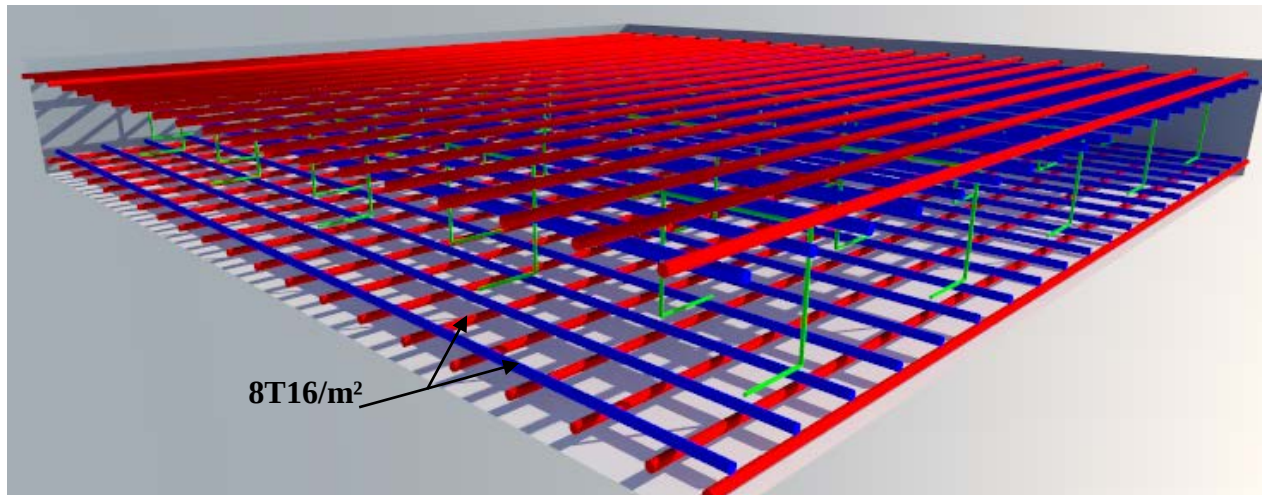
Le schéma du ferrailage de la dalle du radier en 3D.
